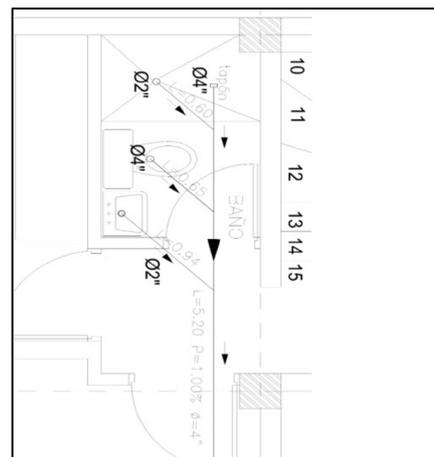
Detalle conexión sanitaria baño 2ºPiso
